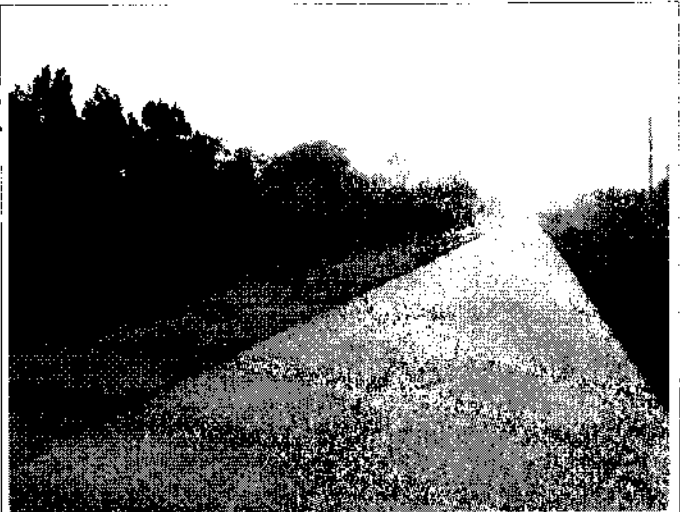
segmento com demanda de recapeamento e finalização da instalação do pavimento.
